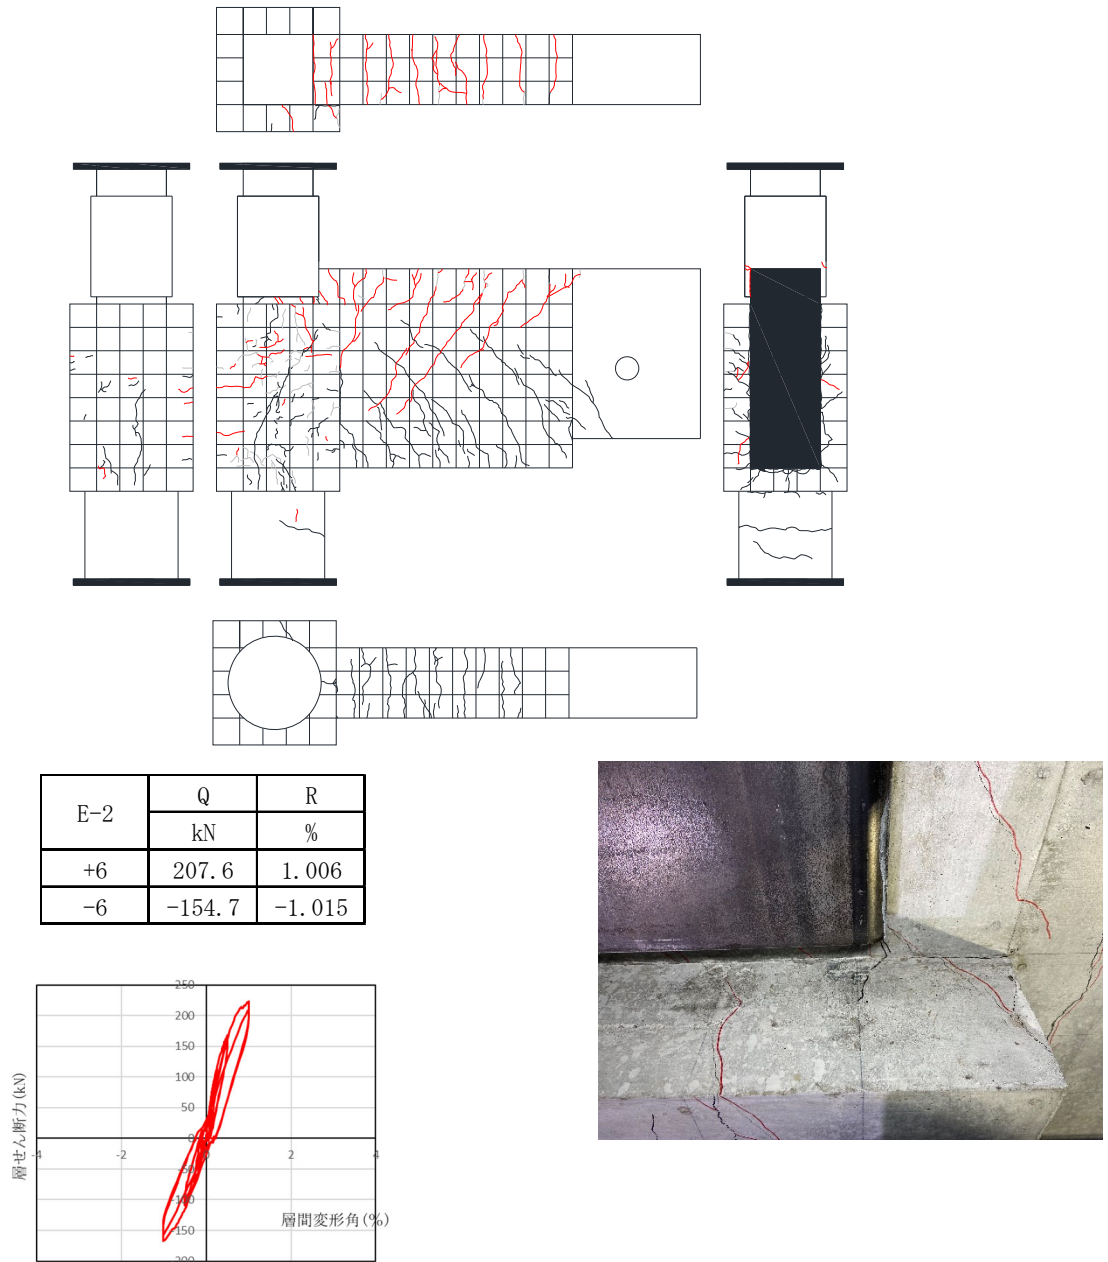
3. 2-14 E-2 ひび割れ状況 (4Cycle)
